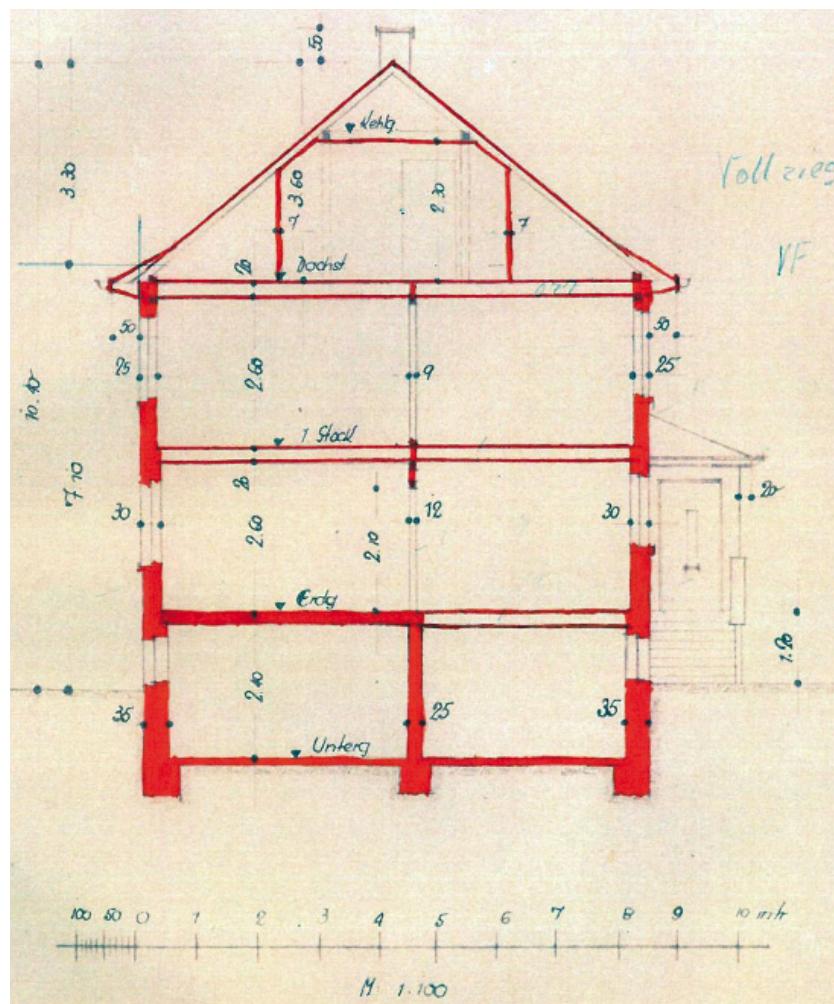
Vertikalschnitt des Wohngebäudes mit stockwerksabhängig unterschiedlichen Außenwanddicken im Plan von 1937. Lediglich über der Garage (siehe Bild 19) war eine Betondecke geplant, ansonsten Holzbalkendecken.
